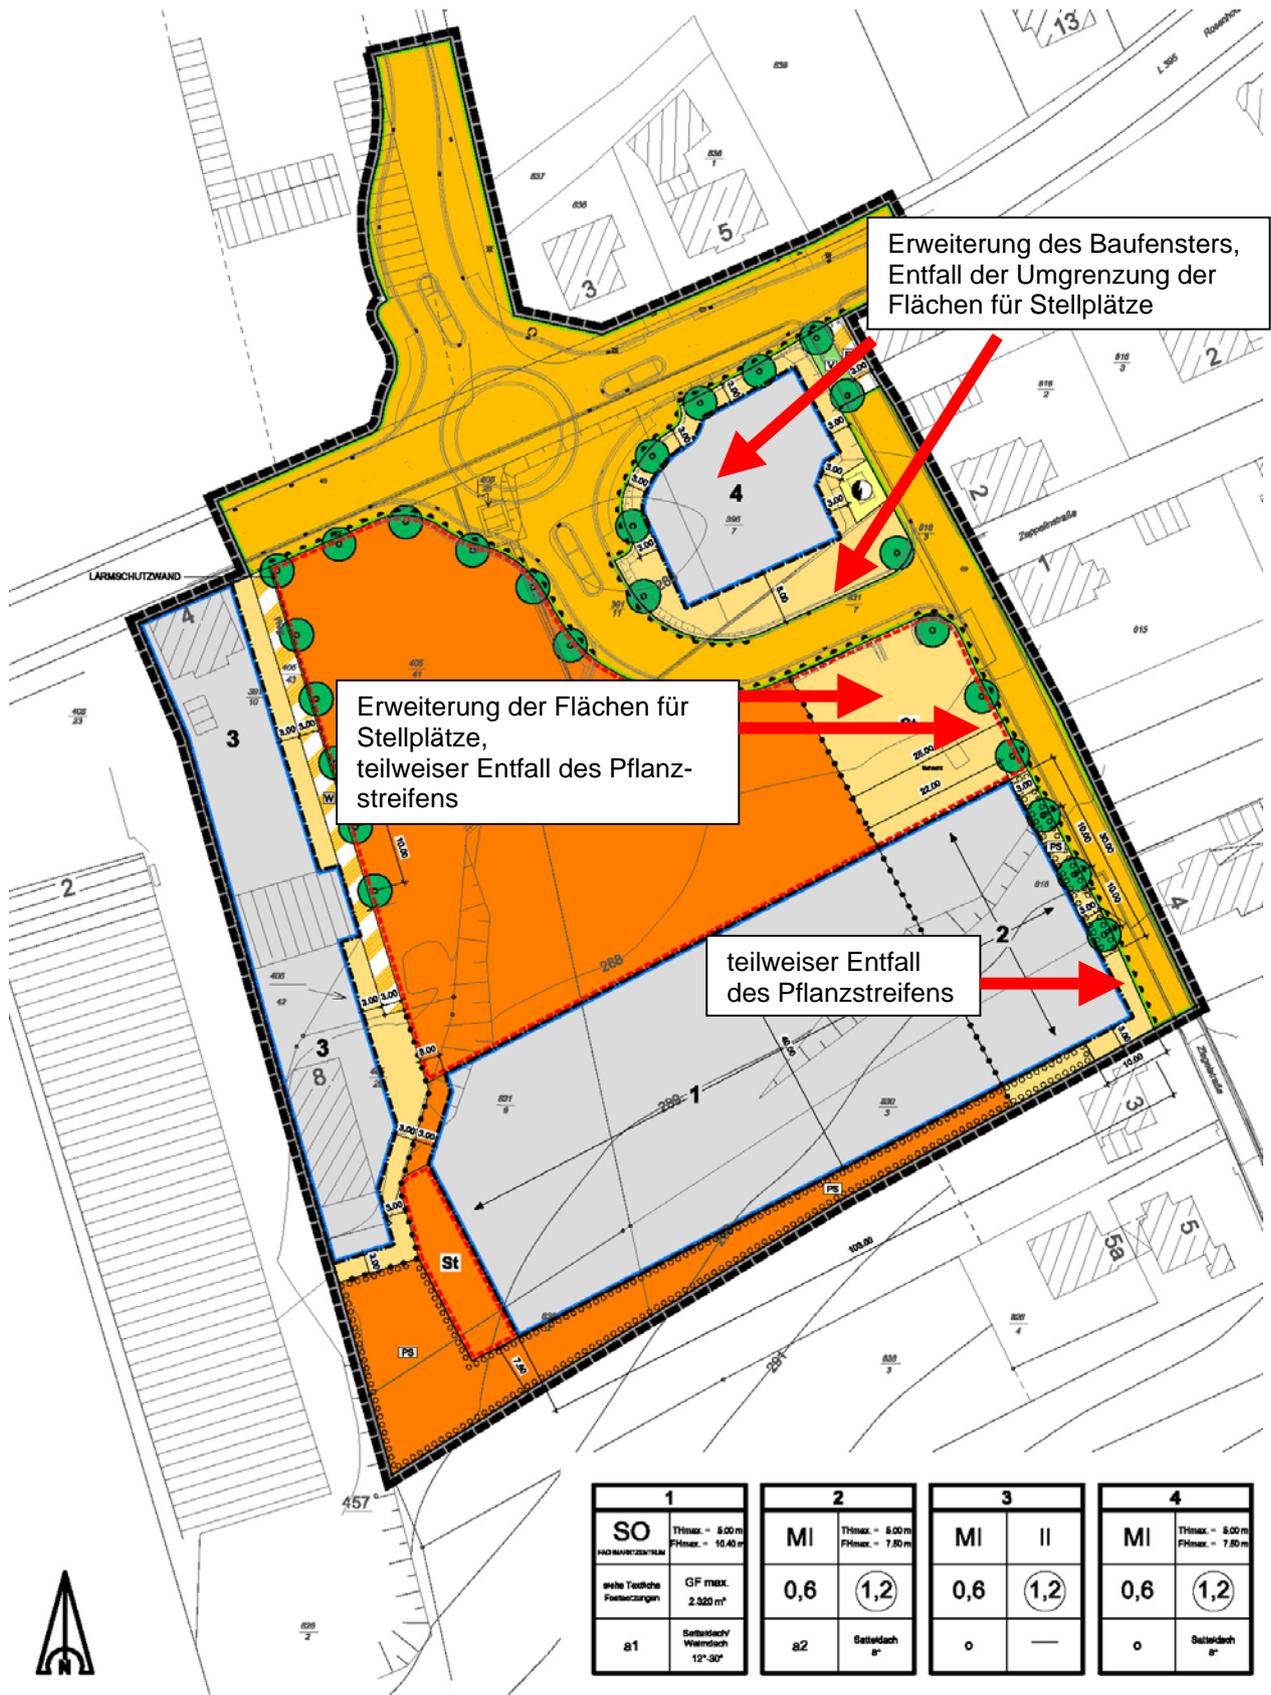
Bebauungsplan „Rosenhofstraße / Ziegelstraße, 2. Änderung“, Stand: Januar 2007
